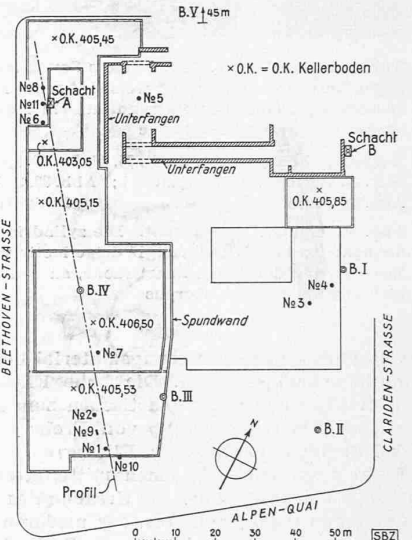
Grundriss 1 : 1700 mit Eintragung der Lage der vorgenommenen Bohrungen und Versuchsrammungen
